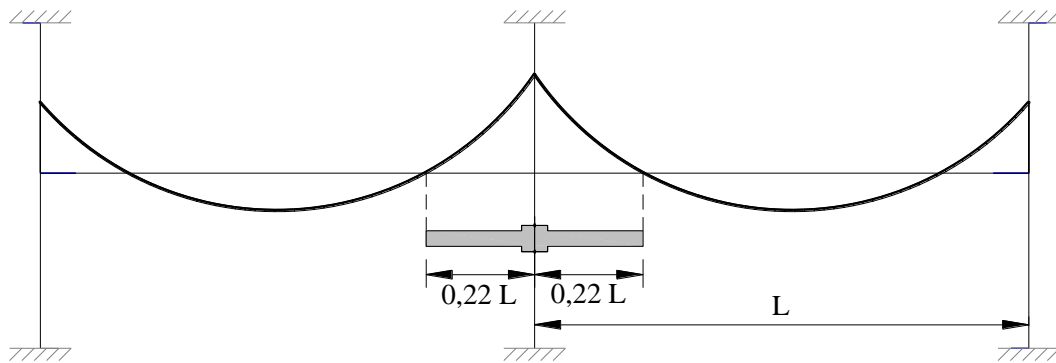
Esquema da ligação Laje-Pilar em estudo
